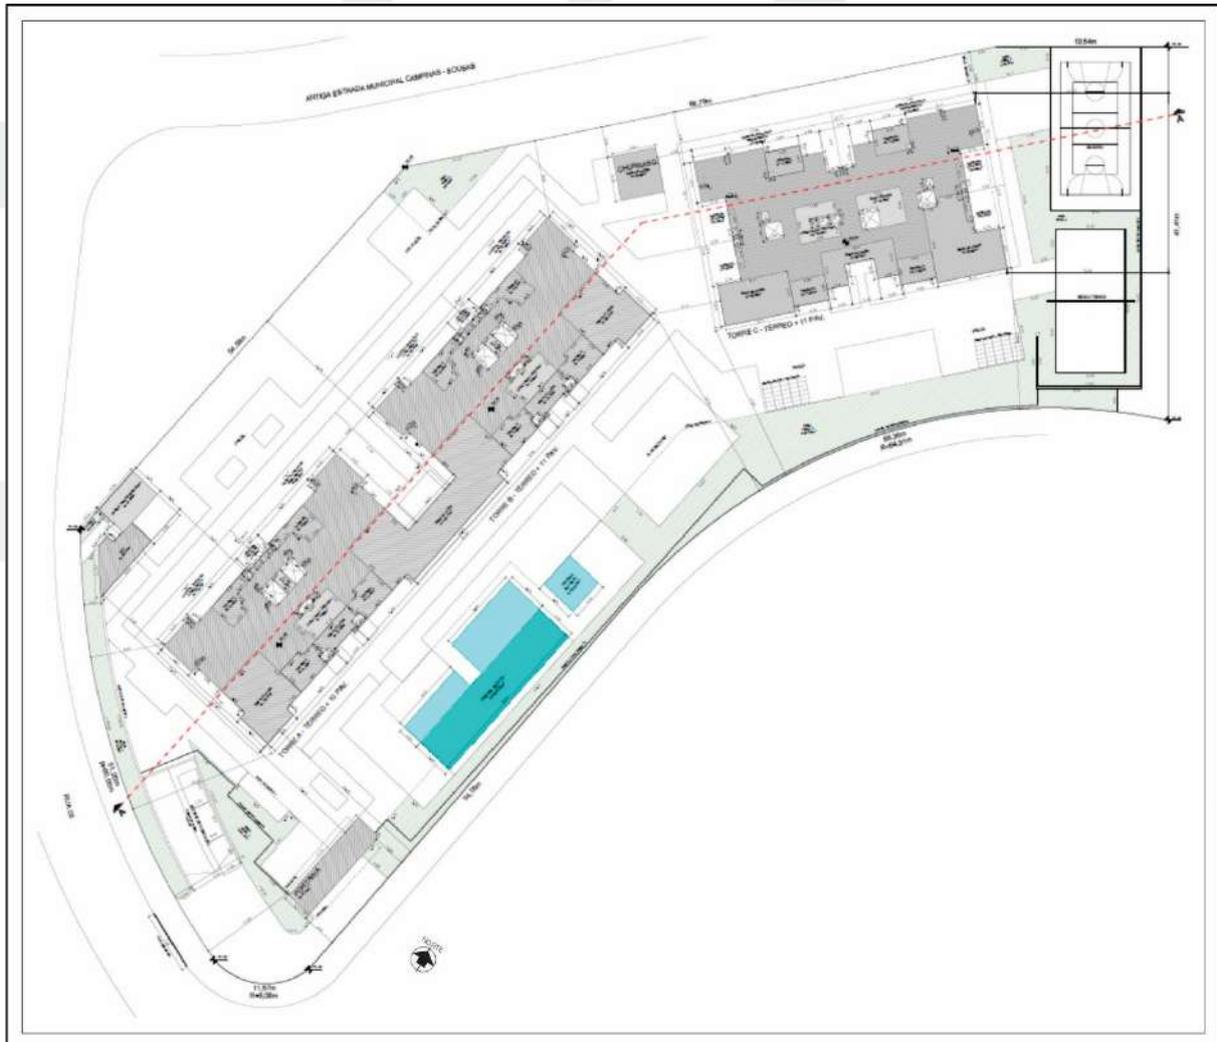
Projeto Arquitetônico - Lote 1D – Fase 4
